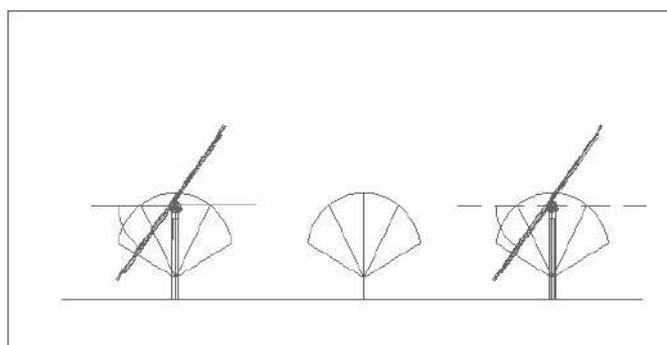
Sovrapposizione oliveto e impianto fotovoltaico oggetto di investimento.
